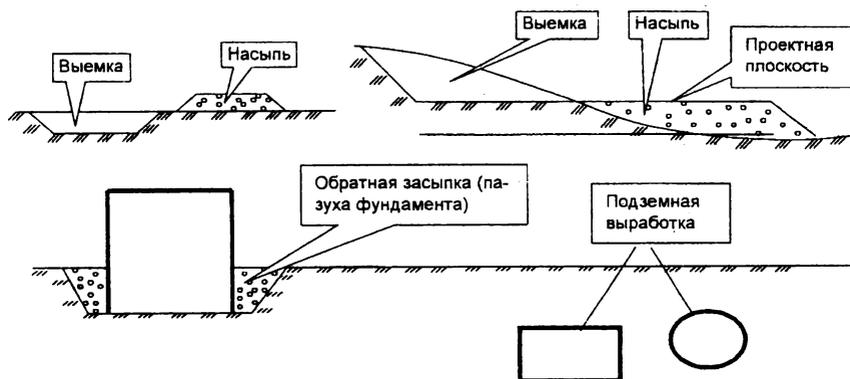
1. Выемки и насыпи, обратные засыпки и подземные выработки.
